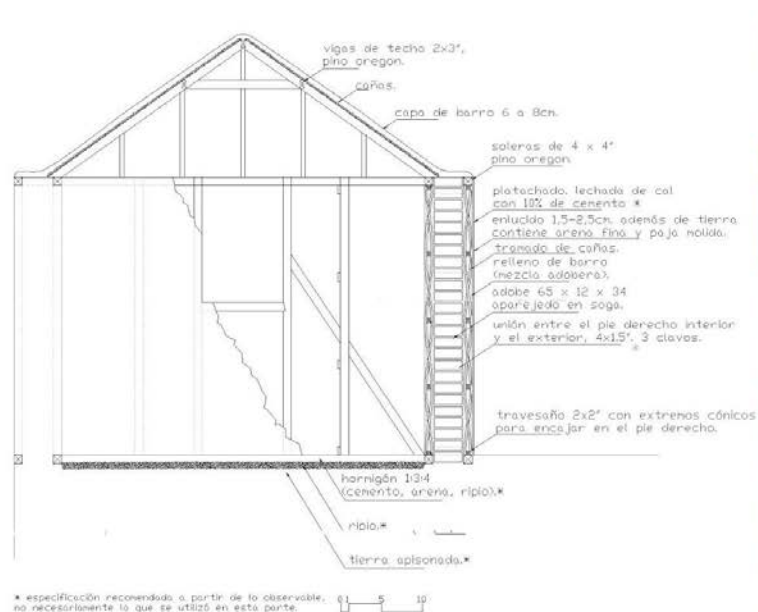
La Casona. Planta y corte mostrando los elementos estructurales del muro
